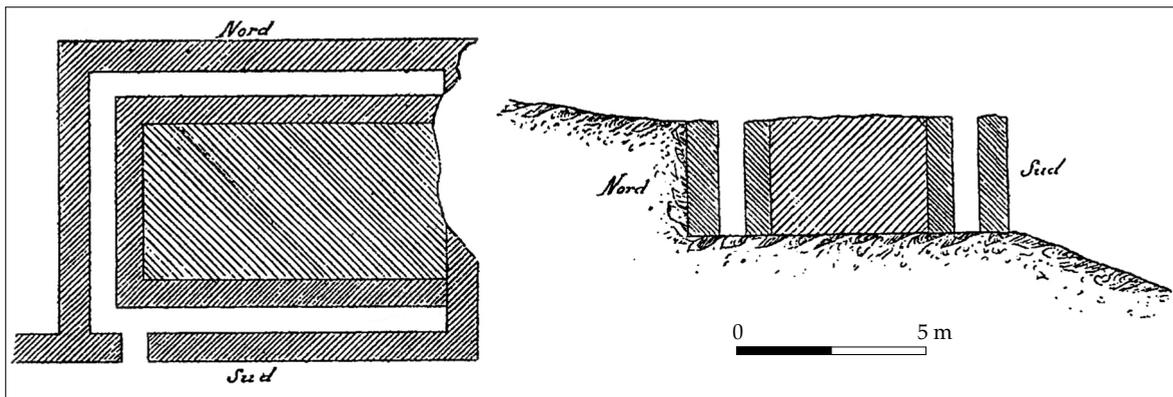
Plan et coupe des latrines (Lièvre 1896, 218-219).
